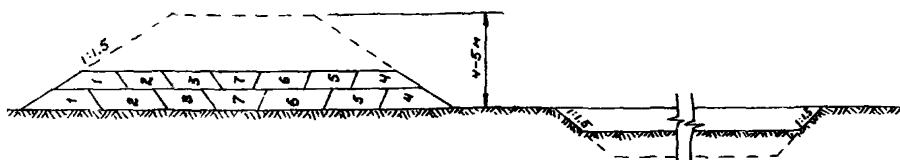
Схема отсыпки насыпей прицепными скреперами из резерва
